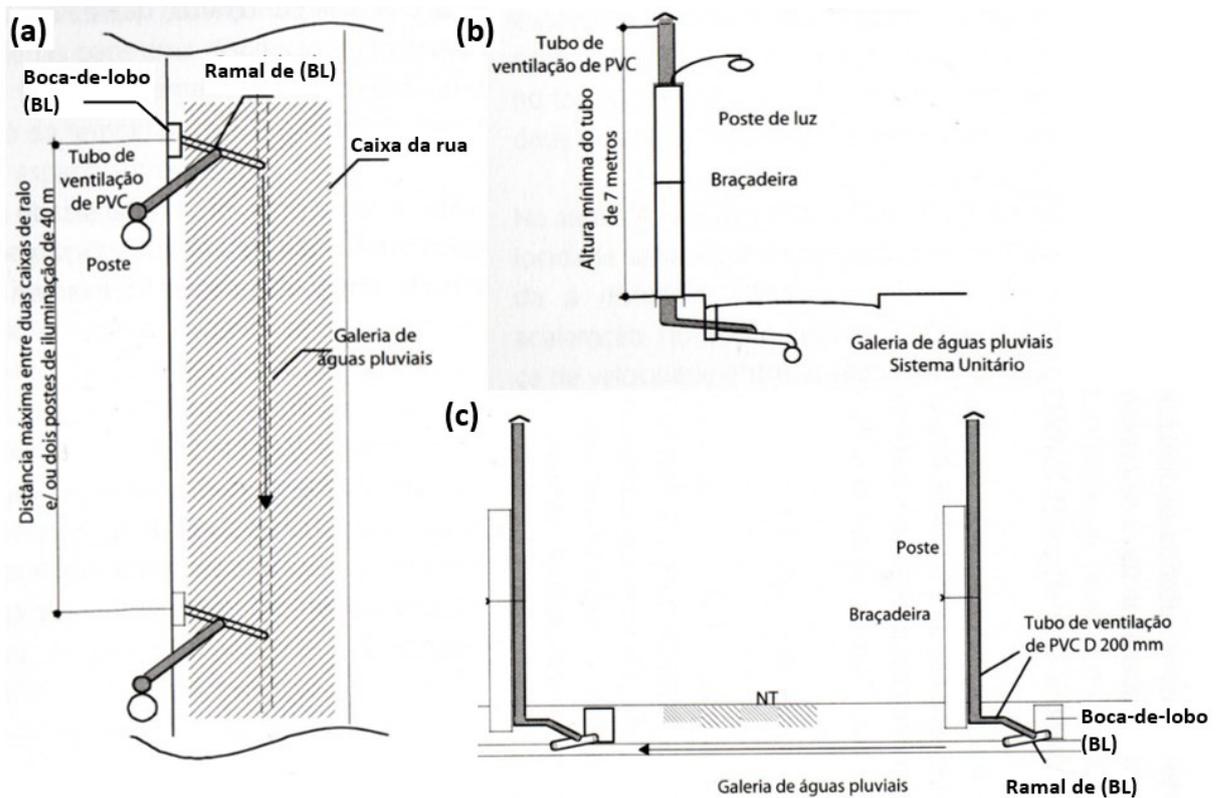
Representação esquemática de chaminé pública de ventilação na rede de drenagem pluvial. (a) planta; (b) seção transversal; e (c) seção longitudinal.
